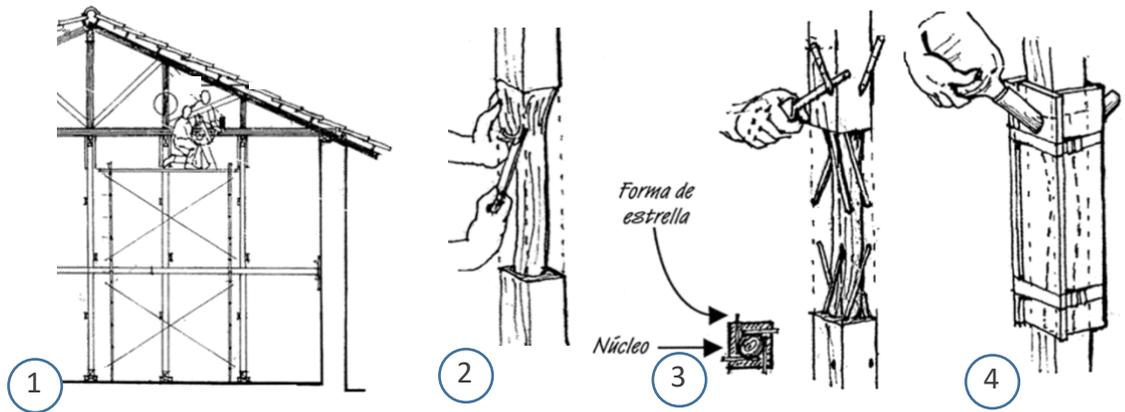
Consolidación de un elemento vertical en armaduras de cubiertas.
